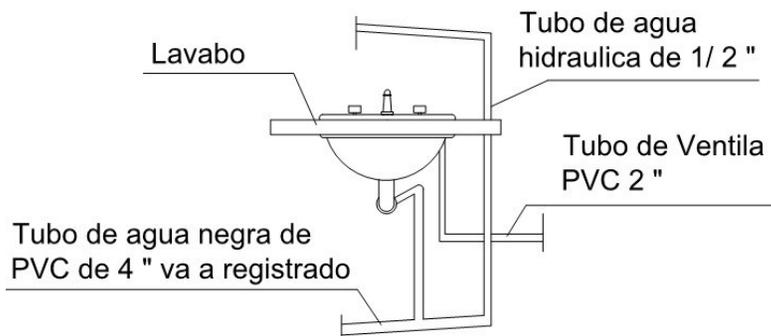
Detalle de instalación lavamanos / Fuente: Elaboración propia
